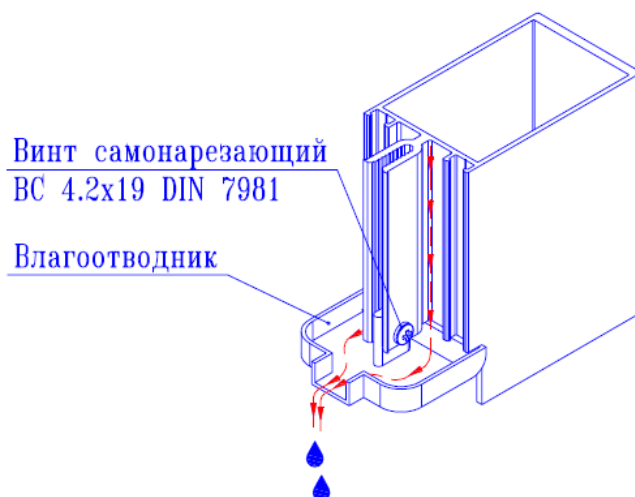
Нижний узел крепления стойки. Установка влагоотводника.
